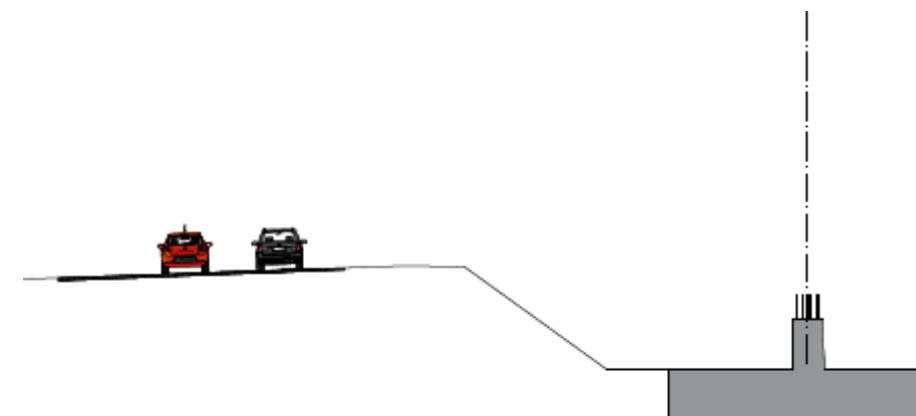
Detalle del desmonte y subestructura del estribo derecho en la fase 0.
